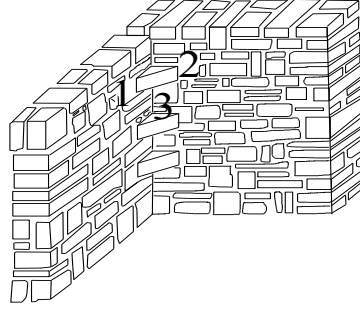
Duvardaki hasarlı kısmın beton ya da grout ile doldurulması
